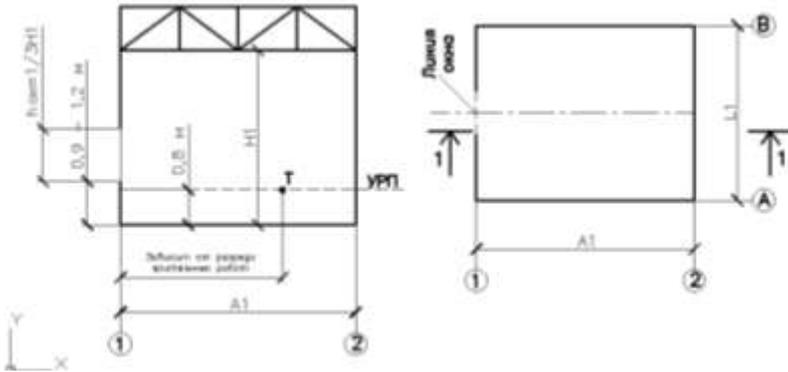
Схема плана и разреза к расчету бокового освещения
